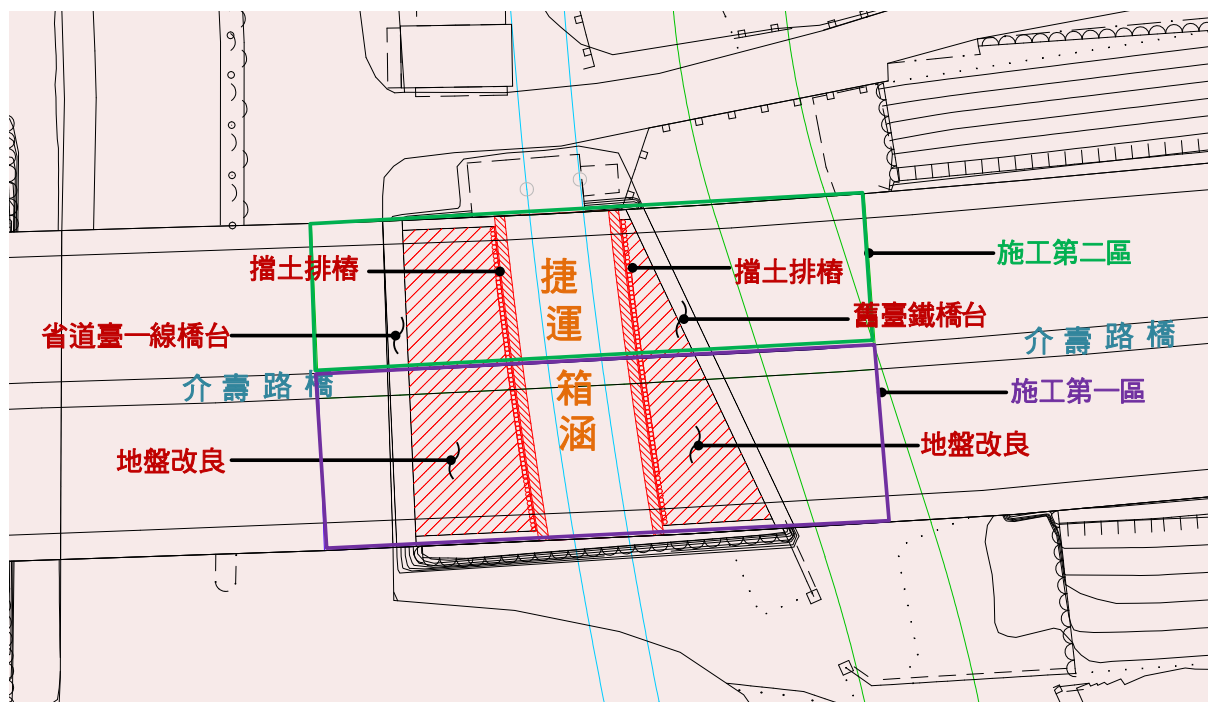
穿越介壽路橋箱涵施工分區平面示意圖
